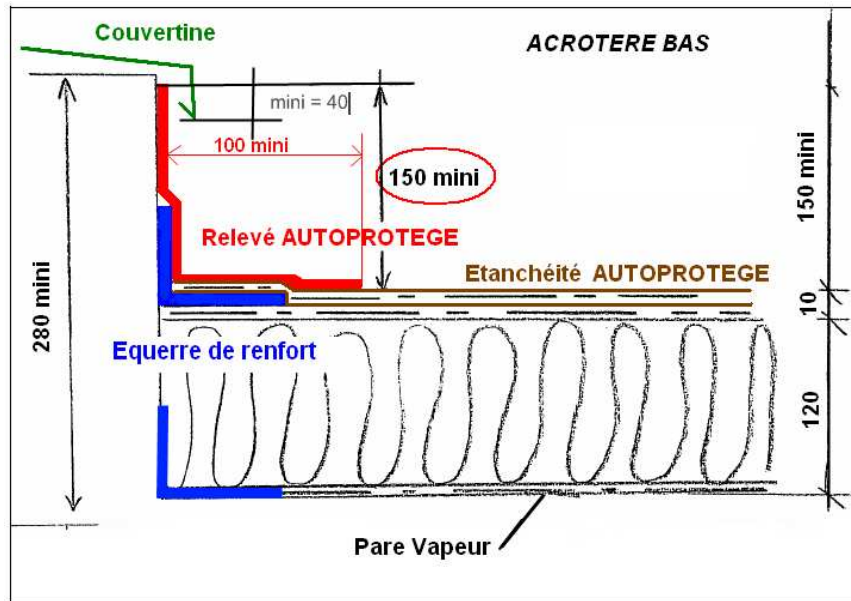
Schéma présentant le système d'étanchéité d'une toiture terrasse.
